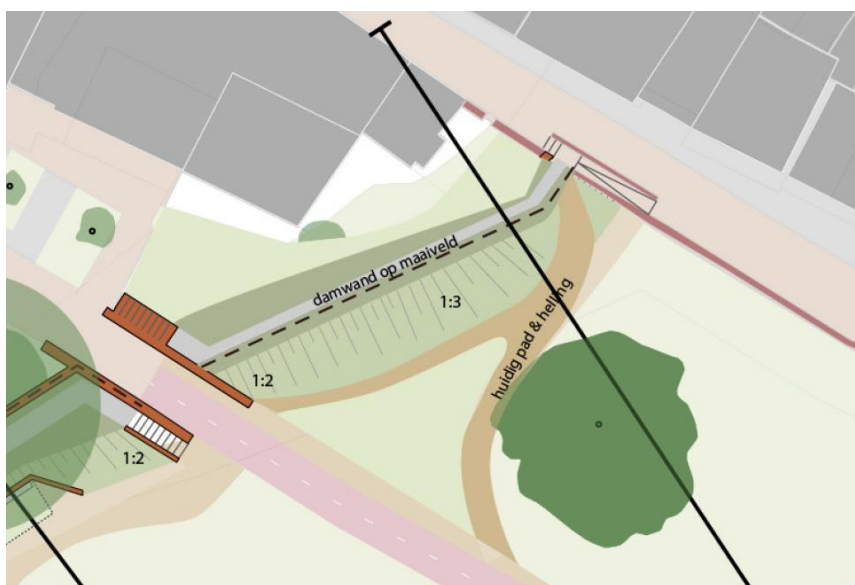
Aanzicht deeltraject 4C: Stadswallen – Ravelijnmuur
